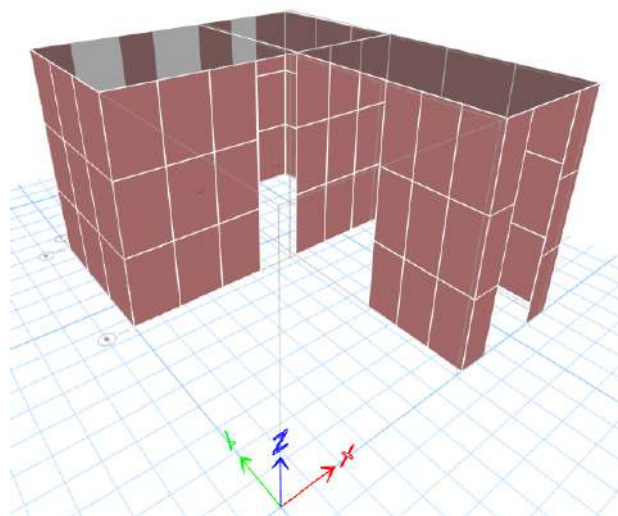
Vista en planta del modelamiento de la vivienda 01
